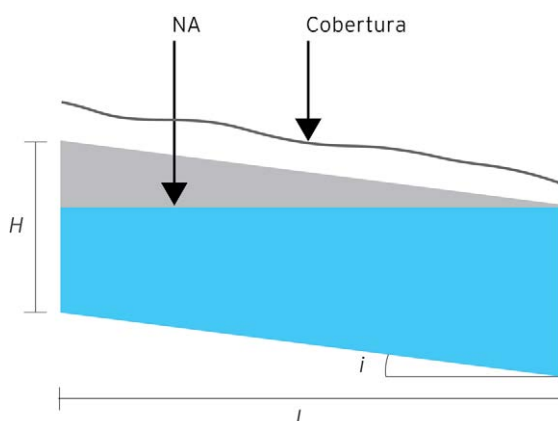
Trincheira de Infiltração - corte longitudinal típico.
